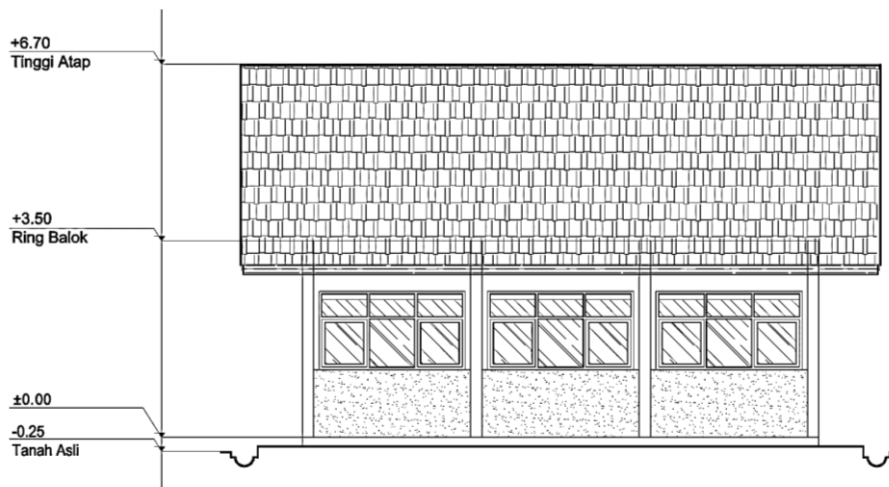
Contoh Tampak Depan Ruang Kelas 1 Rombel
